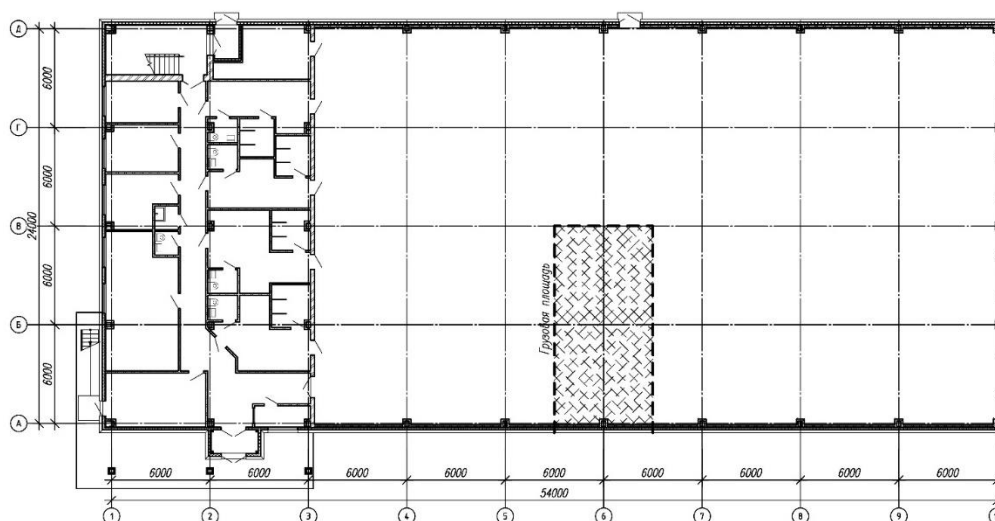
Схема определения грузовой площади для колонны А-6
